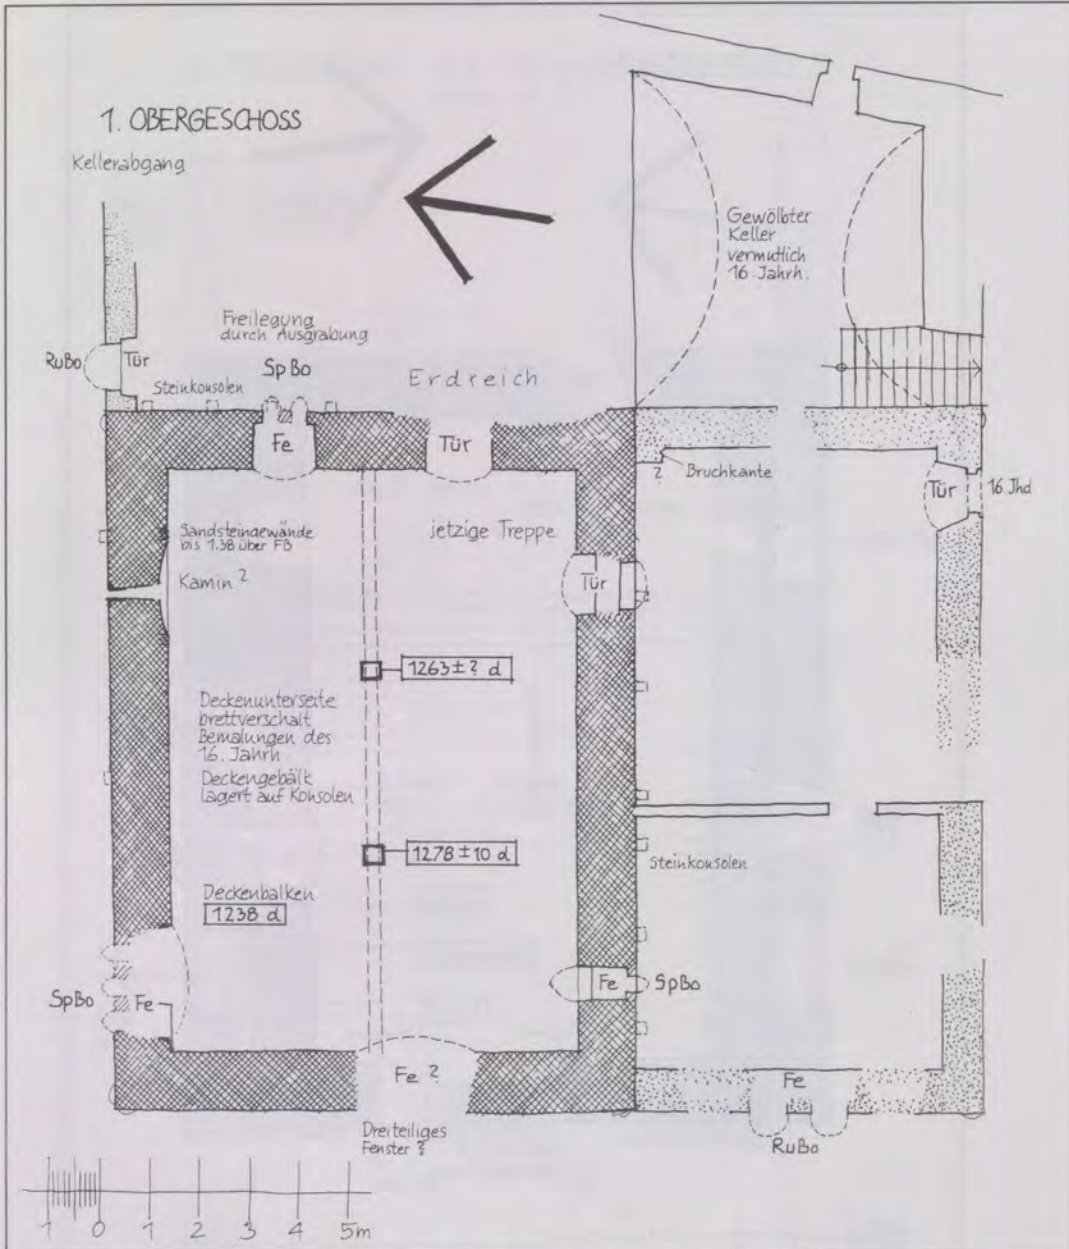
Grundriß 1. Obergeschoß. Legende siehe Erdgeschoß
